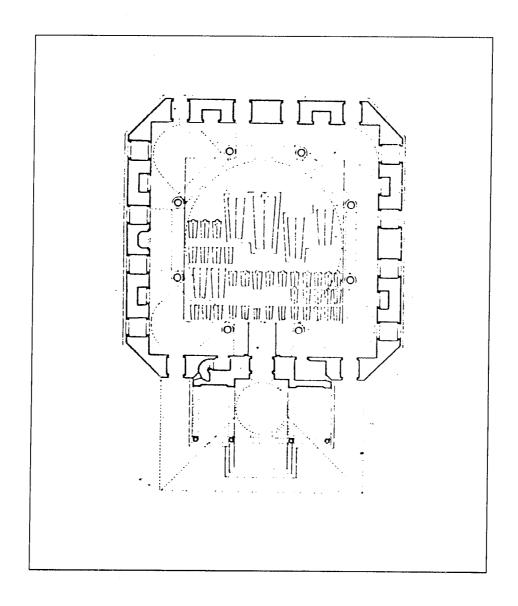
مسقط أفقي لمكتبة راغب باشا في إستانبول (عن : جودوين) .
